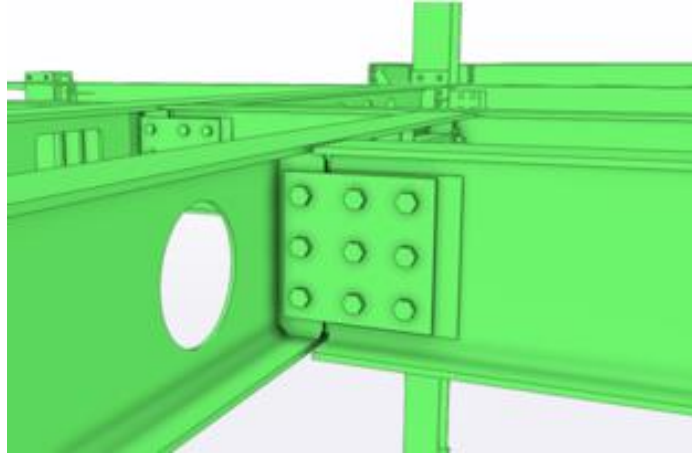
Ligação *Viga – Viga*, utilizando o Método *Coluna – Viga* (Fonte: Software Tekla, 2023)
